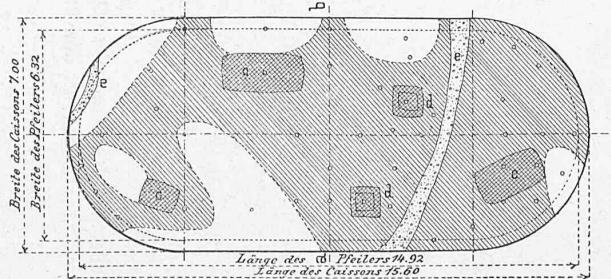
Grundriss des 2<sup>ten</sup> Pfeilers
